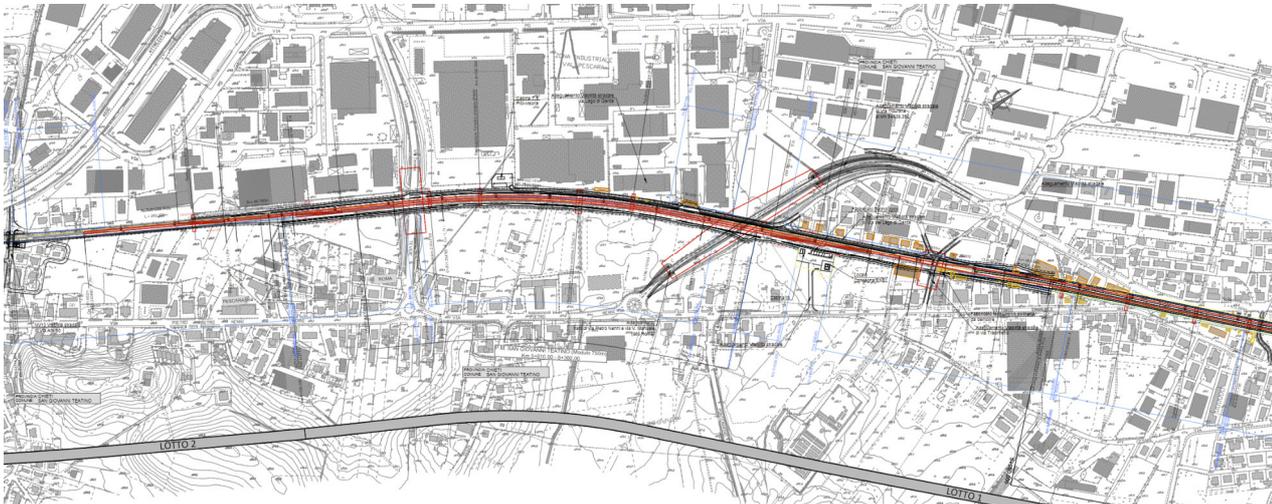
Planimetria raddoppio da pk 4+650 a pk 6+869
